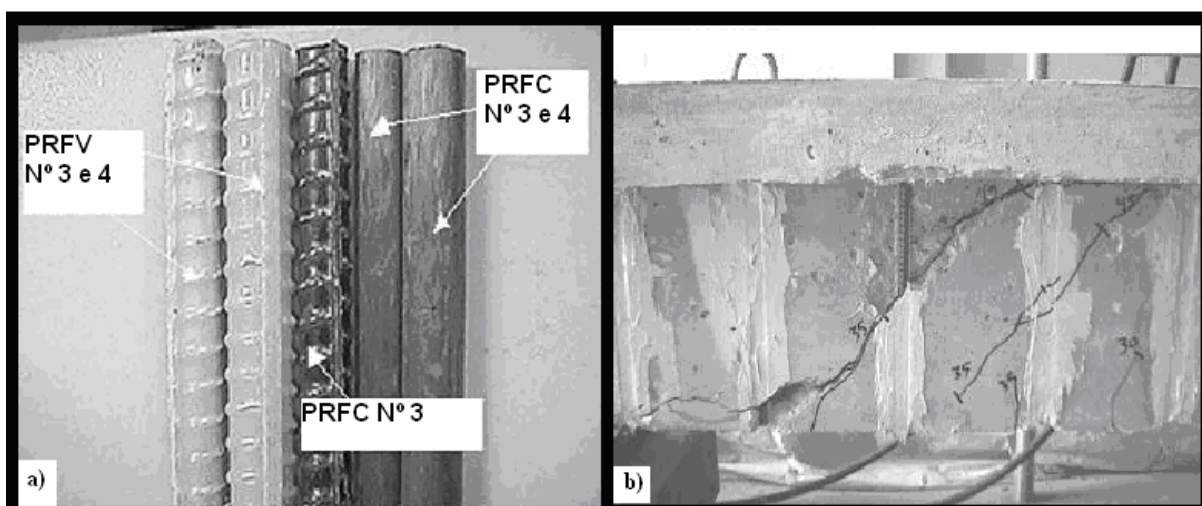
a) Tipos de barras de PRFC e b) fissuração de viga após ensaio (DE LORENZIS *et al.* 2001).
